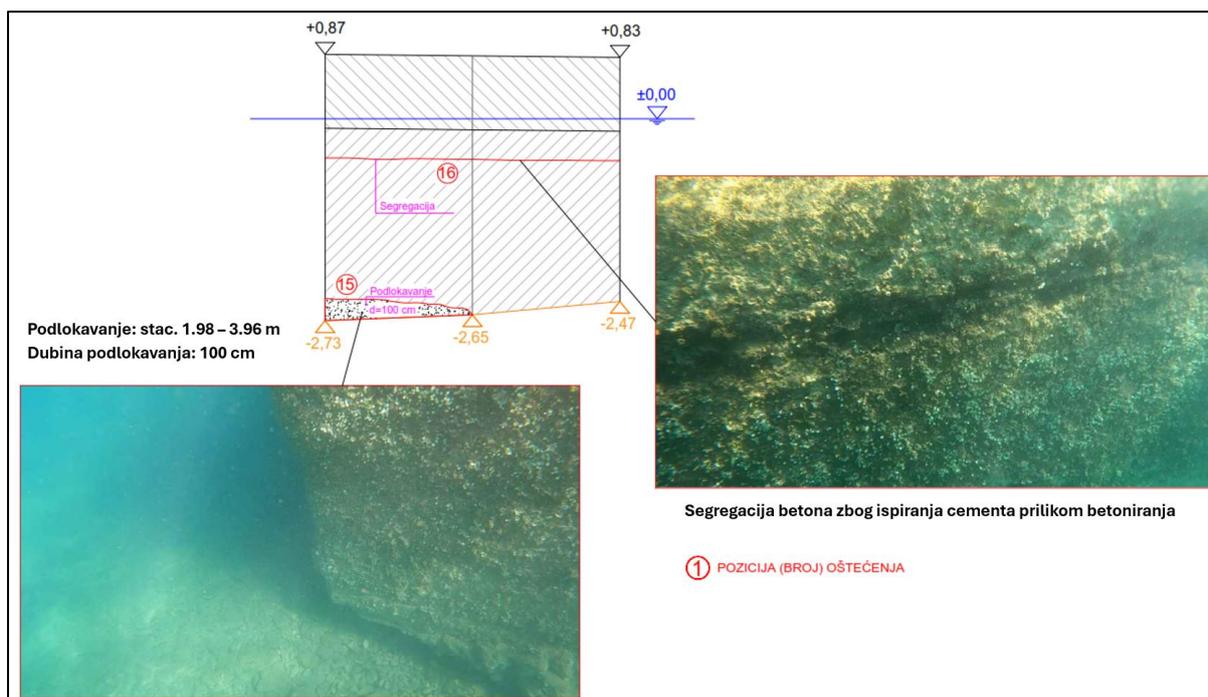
Prikaz oštećenja (Pogled „B“), podlokavanja i segregacija betona zbog ispiranja cementa prilikom betoniranja
